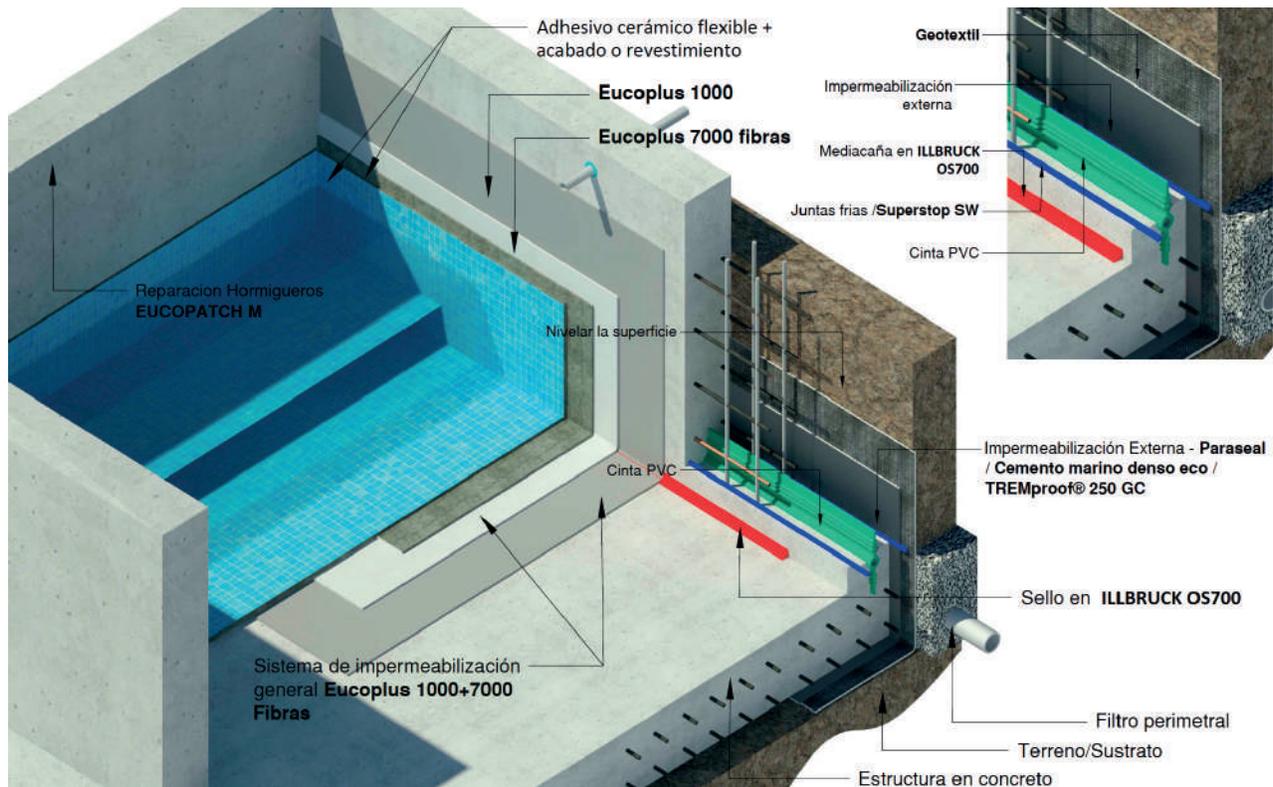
Detalle impermeabilización exterior de la estructura la piscina.
